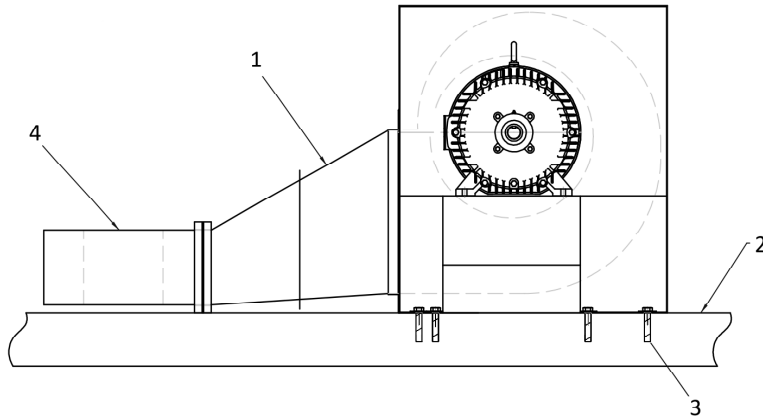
Ventilateur monté sur dalle (ventilateur centrifuge)
